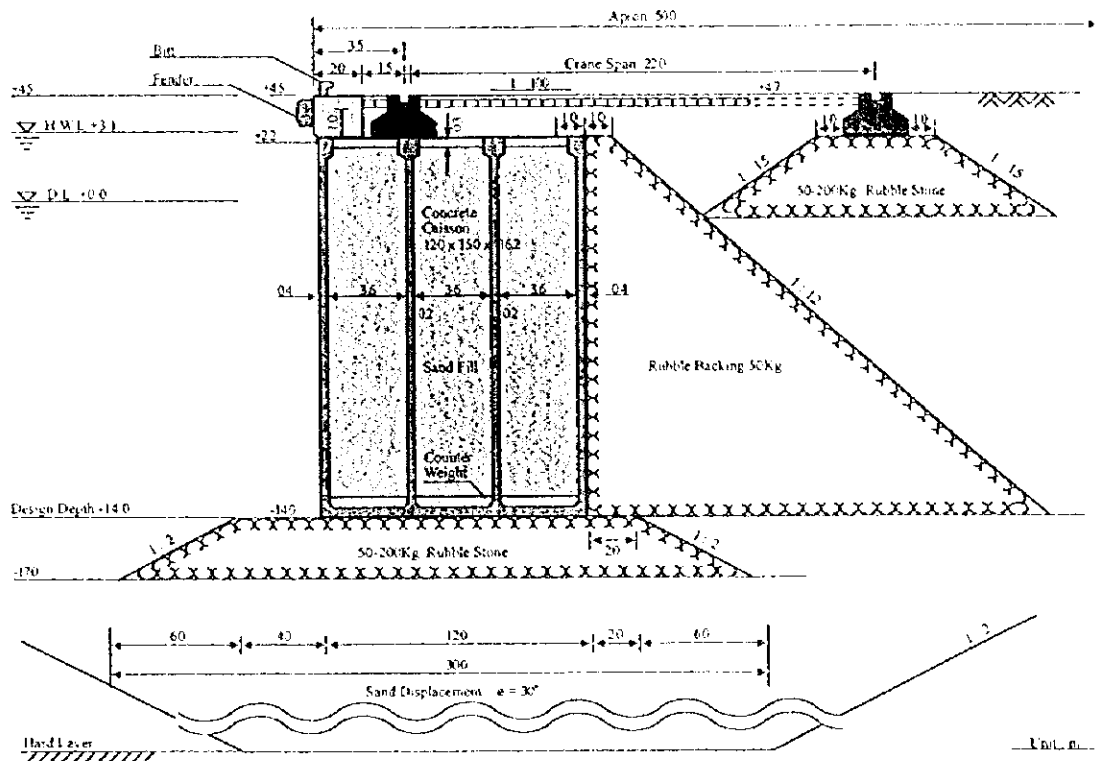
Atracadero de Contenedores/ Atracadero para Carga a granel tipo Campana Neumática de Hormigón (-14m)
